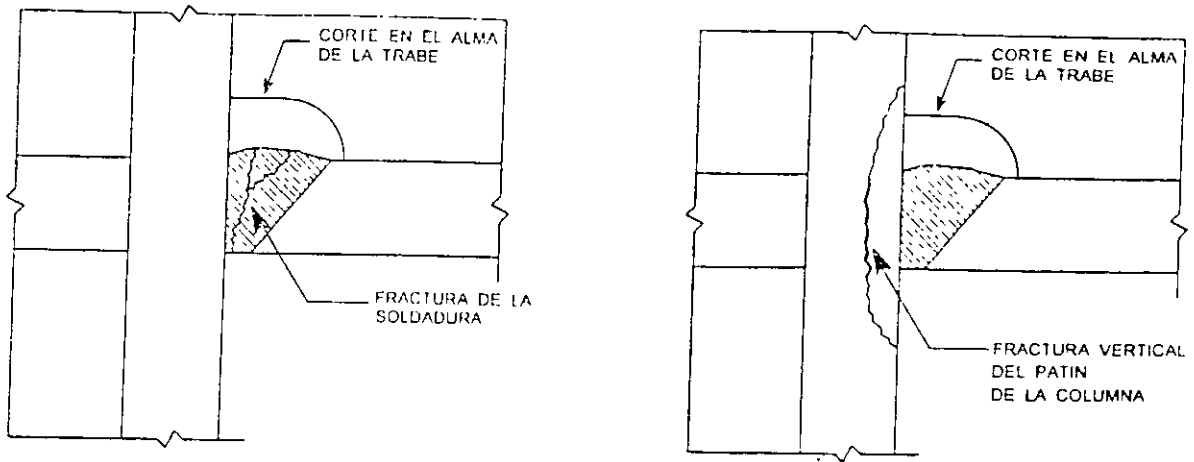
Fractura en la soldadura y fractura vertical en el patín de la columna
